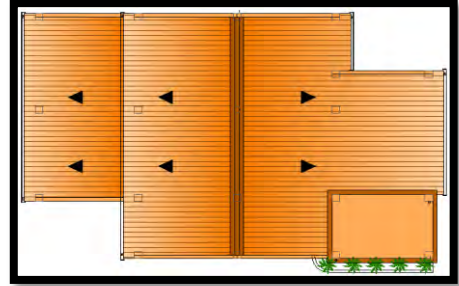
Planta segundo piso Bloque cafetería y administración.
